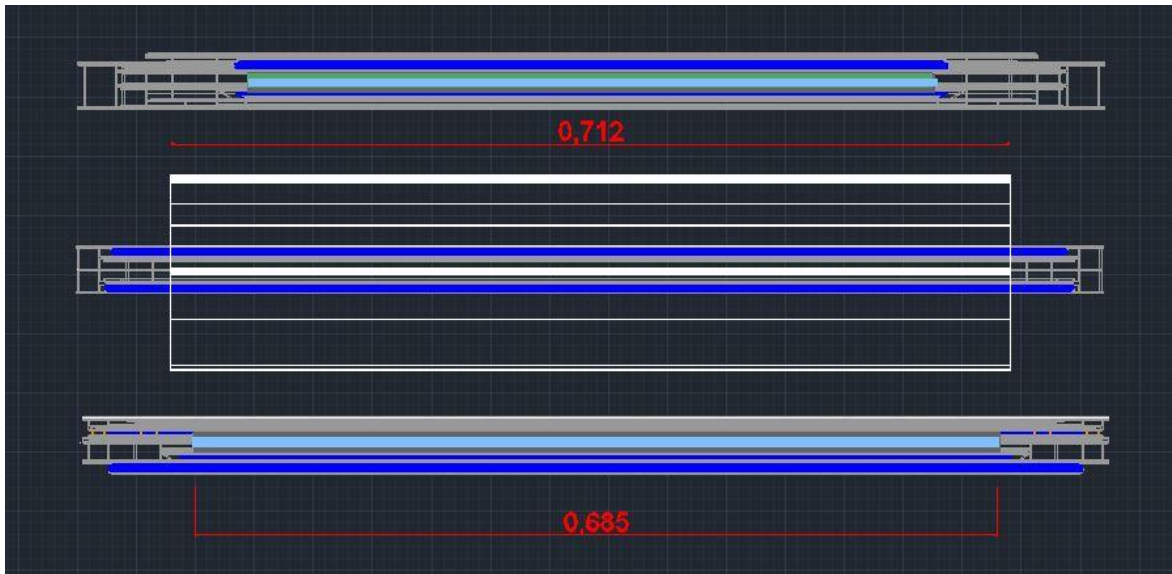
Caso de Estudo 1 – Vista de cima, dimensões (m) de comprimento de lamelas e vidro
